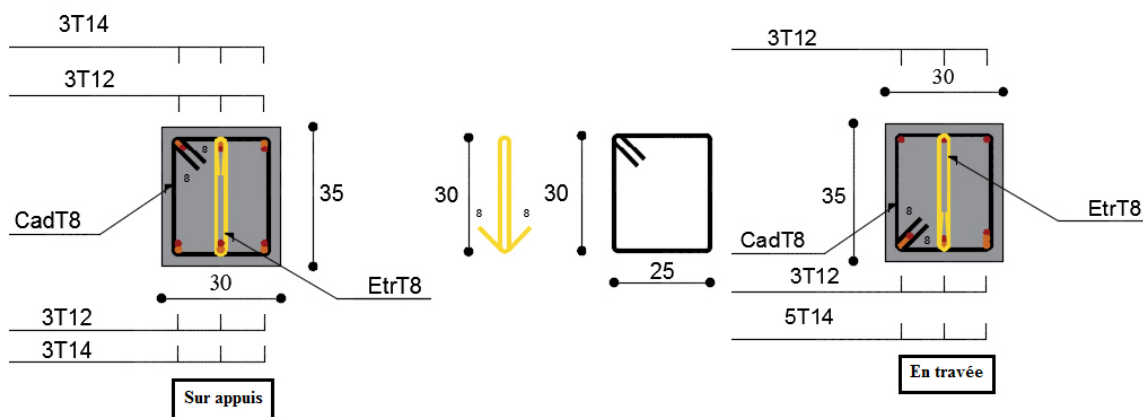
schéma de ferrillage des poutres secondaire en travée et en appuis (bloc B).
